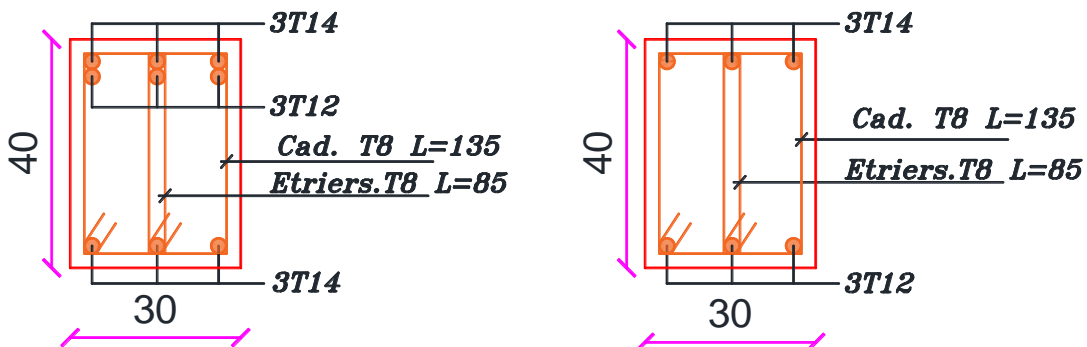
Schéma de ferrailage de la poutre secondaire.
